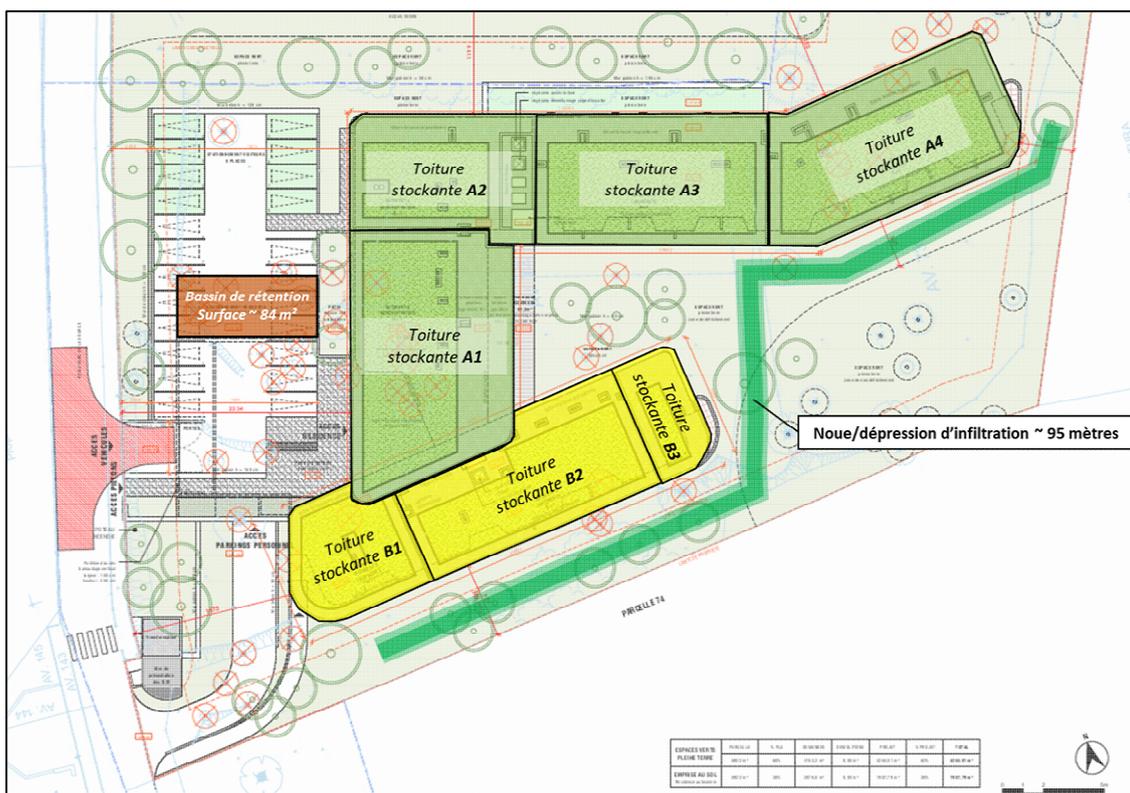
Plan schématique de la position des ouvrages sur le projet.
